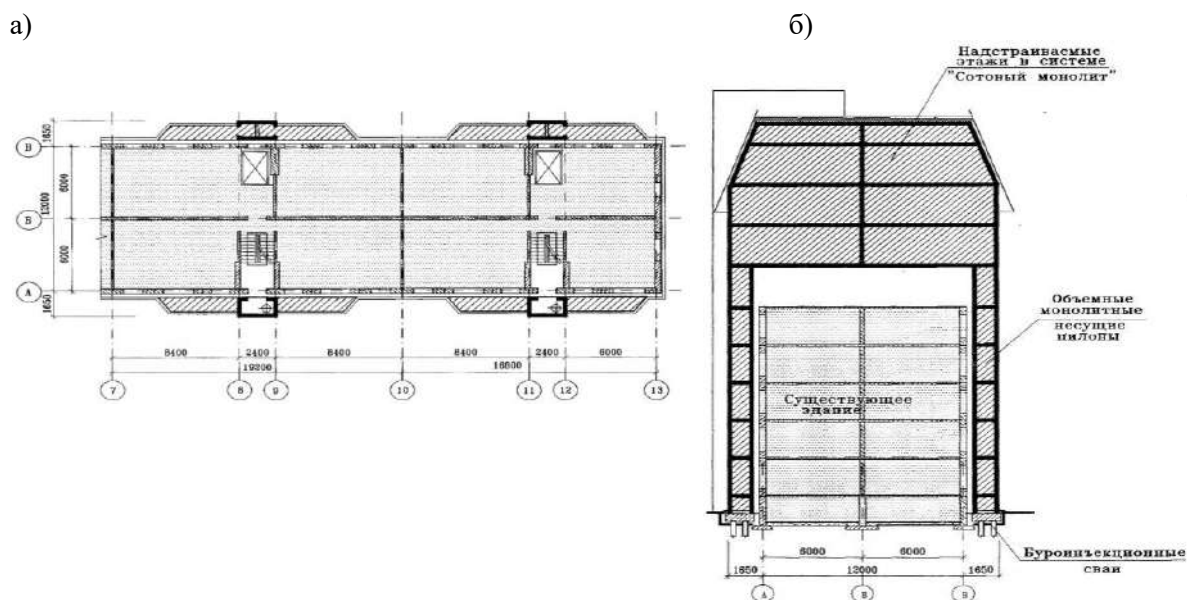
Реконструируемое здание: а – фрагмент плана 2-6 этажей; б – разрез здания
